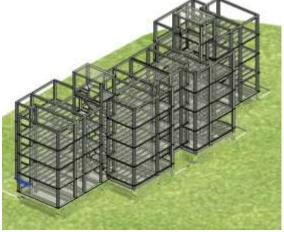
Modelo arquitectónico Revit Ilustración 2: Modelo estructural Revit
